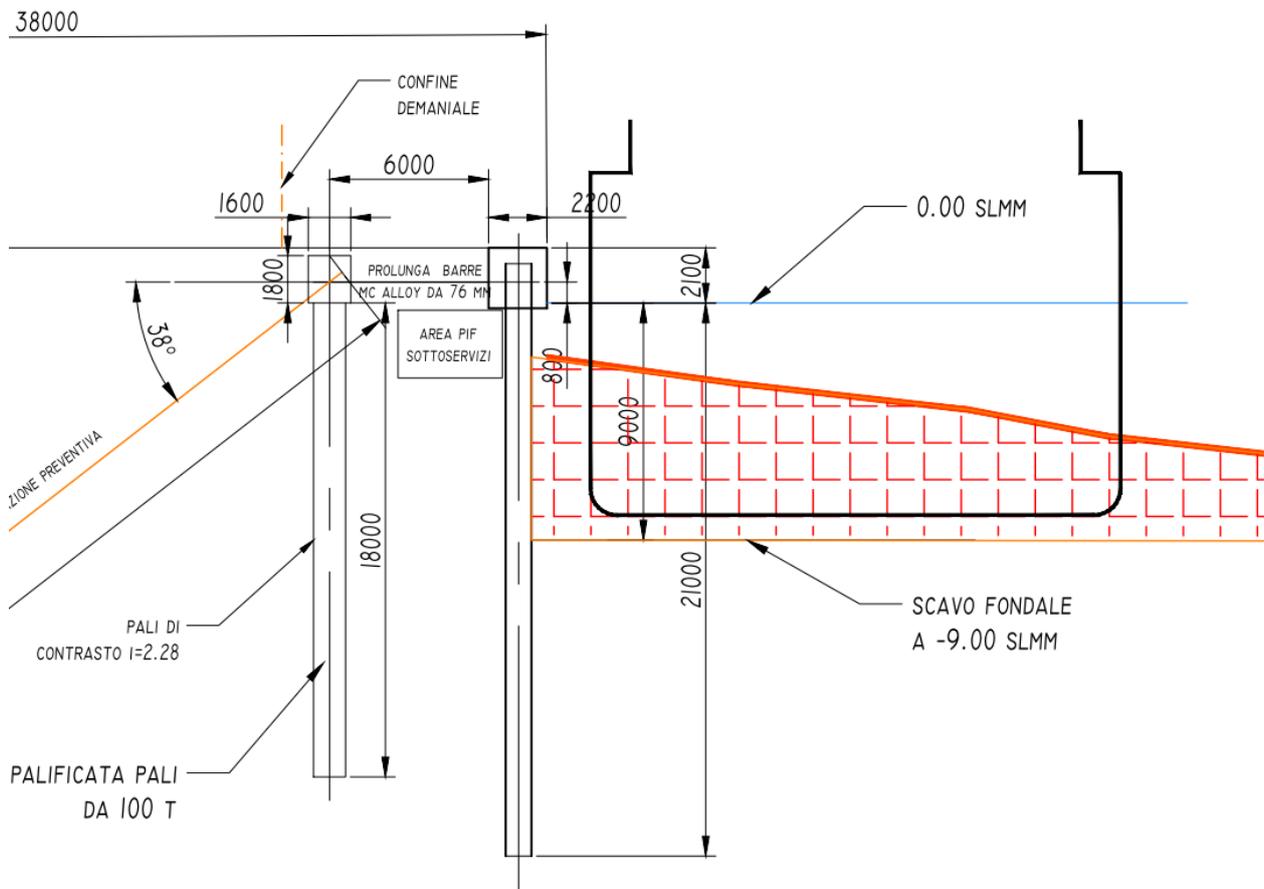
sezione di progetto oggetto di modifica dell'ATF.
